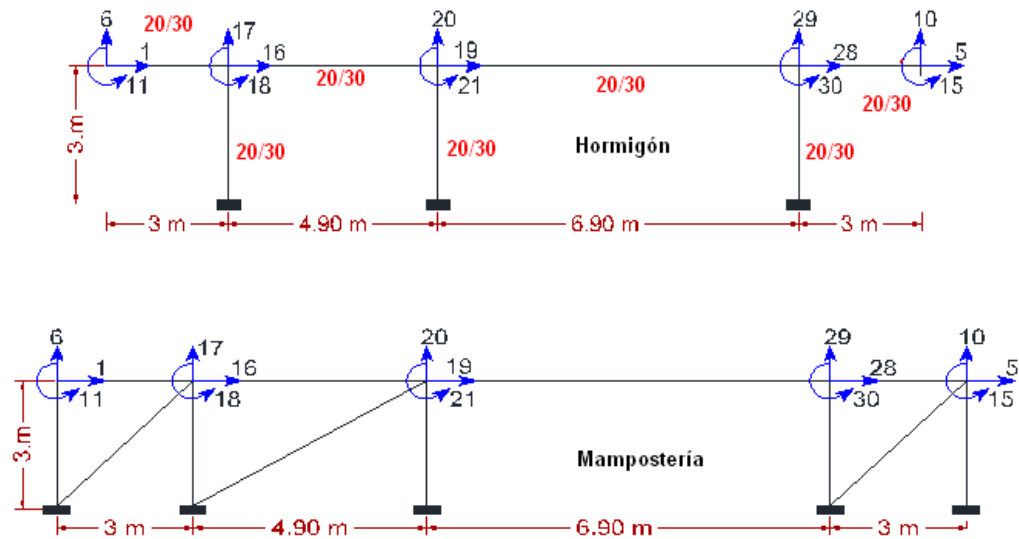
Pórtico exterior de hormigón armado, mampostería y elementos de acero
